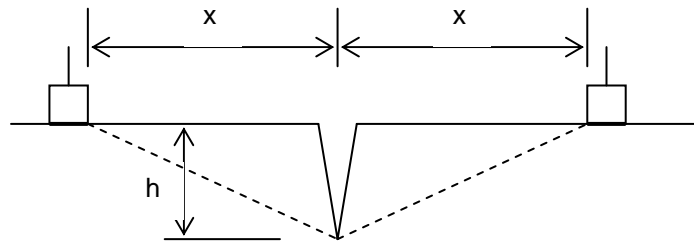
Determinação da profundidade de zonas fendilhadas
